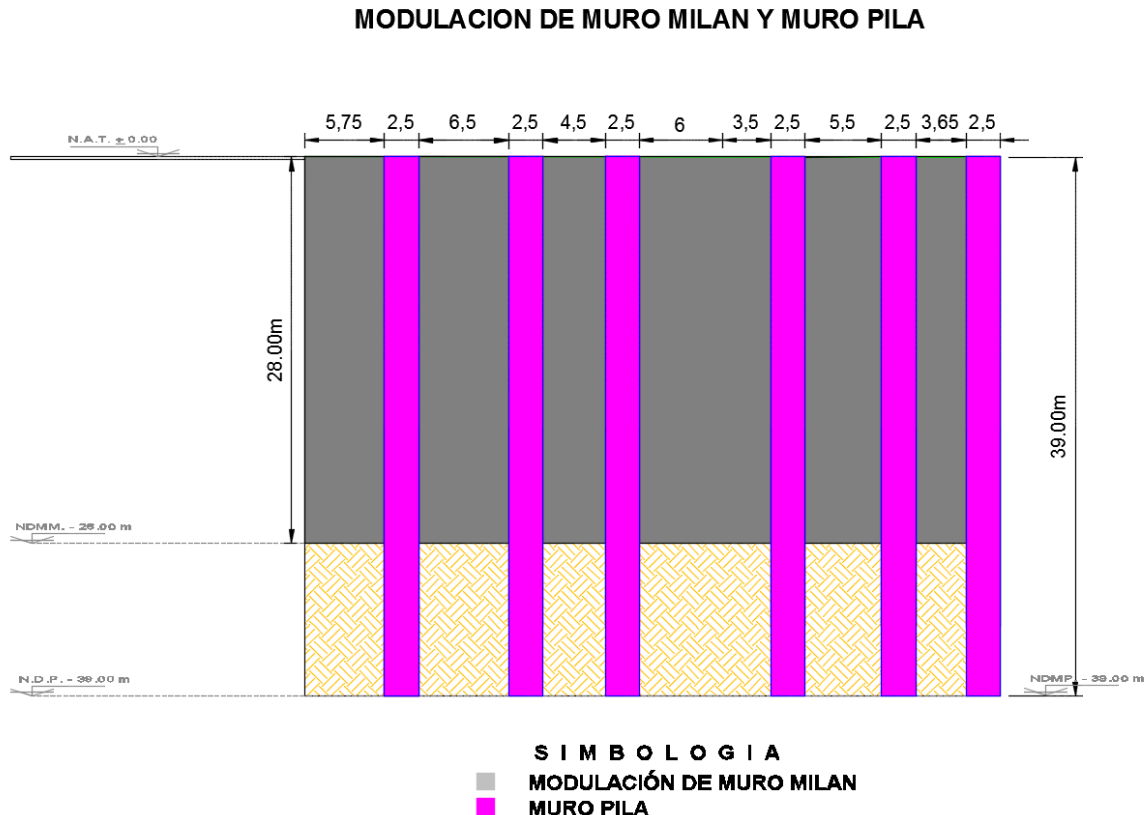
MURO PILA CON EMPOTRAMIENTO MINIMODE 15m DE LONGITUD
